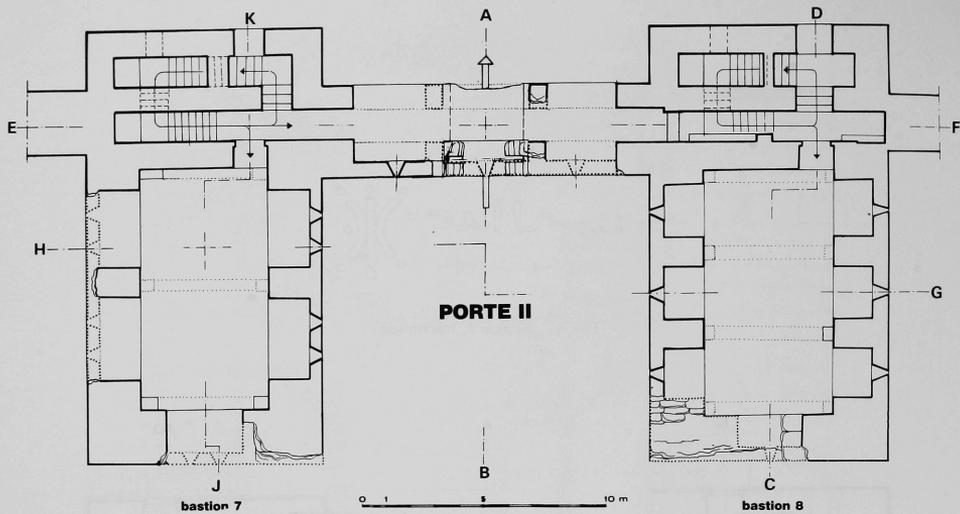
Porte II, bastions 7 et 8, plan du 1^{er} étage au niveau UT.
